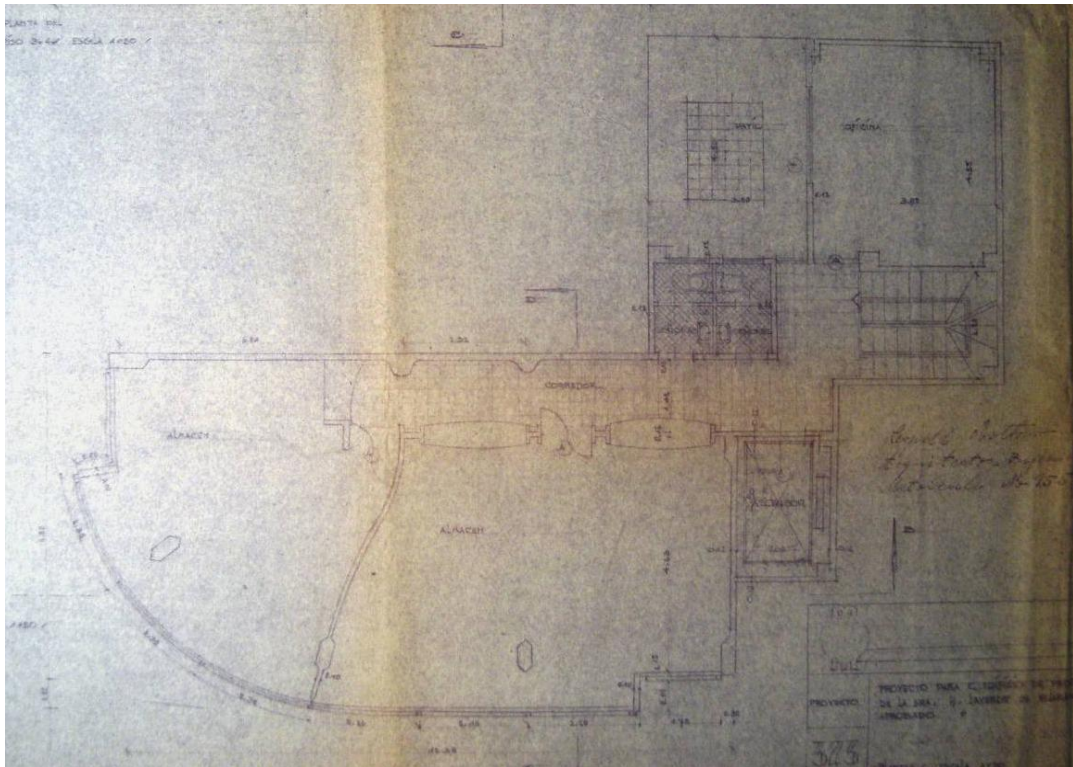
Grundriss des Obergeschosses, von Rother gezeichnet.
